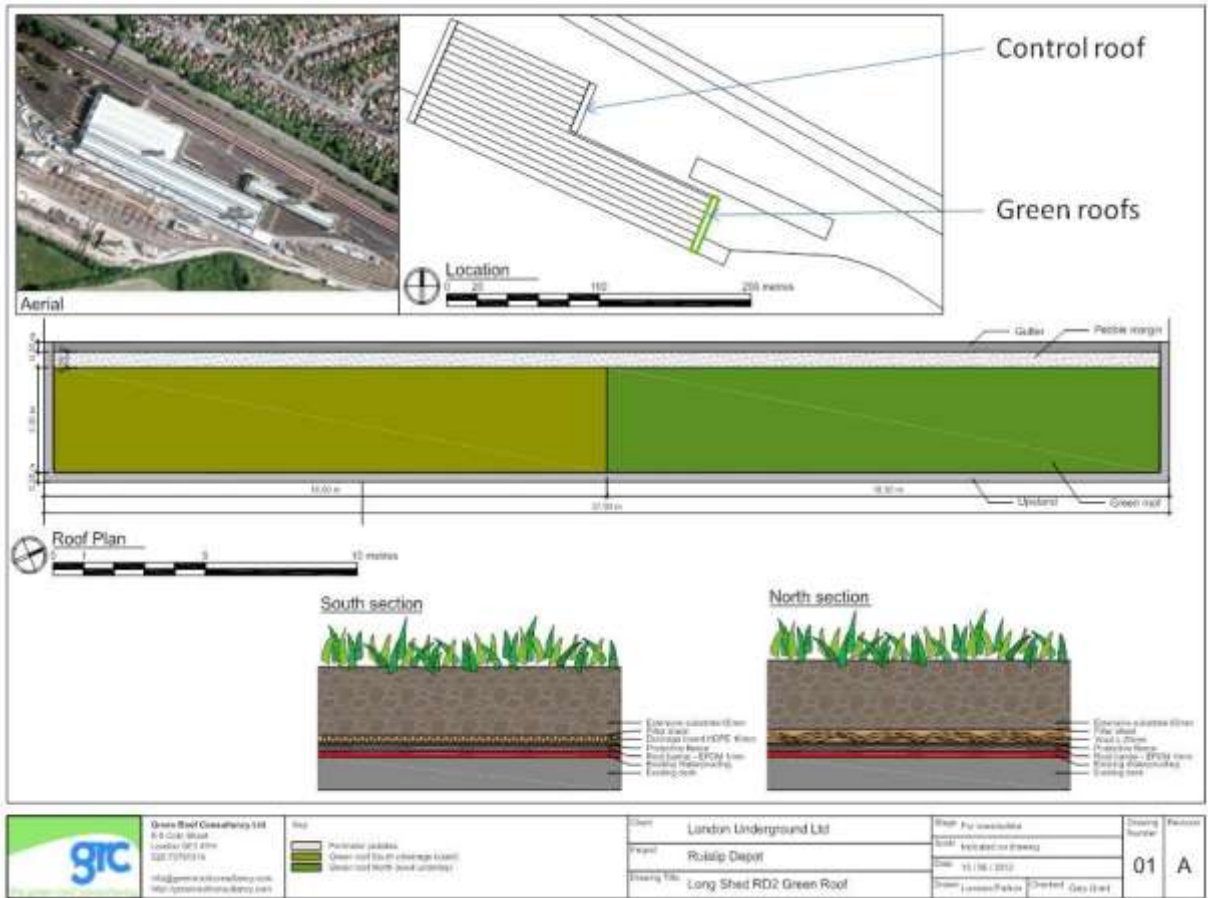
Design do telhado verde - seção norte e sul (© Green Roof Consultancy Ltd, 2013)
